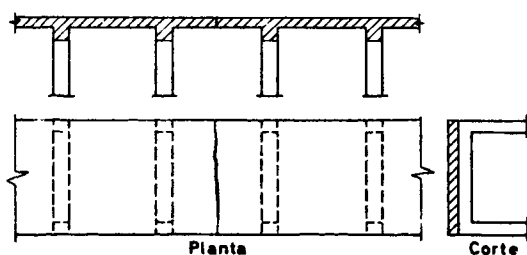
Grietas por retracción en un sistema de losas con dos bordes libres. Citado por Bukowski¹.
